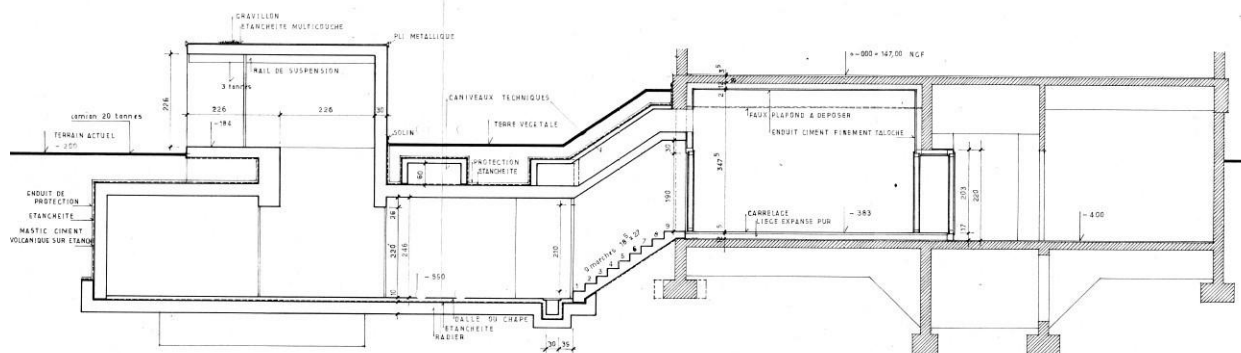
CNB520 - Coupe sur escalier de liaison
